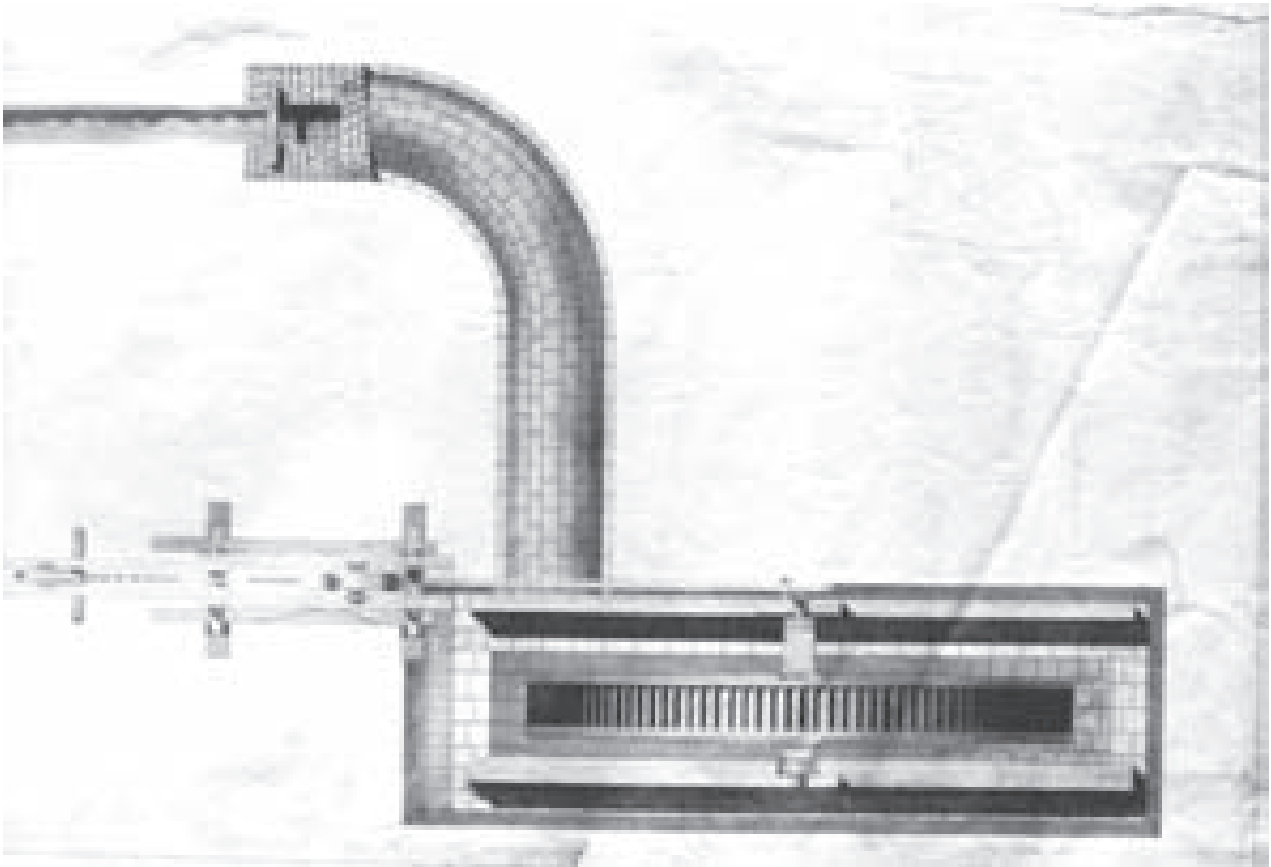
Kunstradstube am Knesebeck-Schacht. Grundriß, 1859 (aus Abb. 3).
